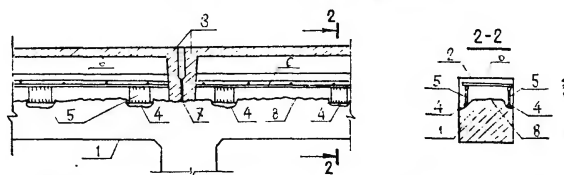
Устройство железобетонной обоймы по верхнему поясу
